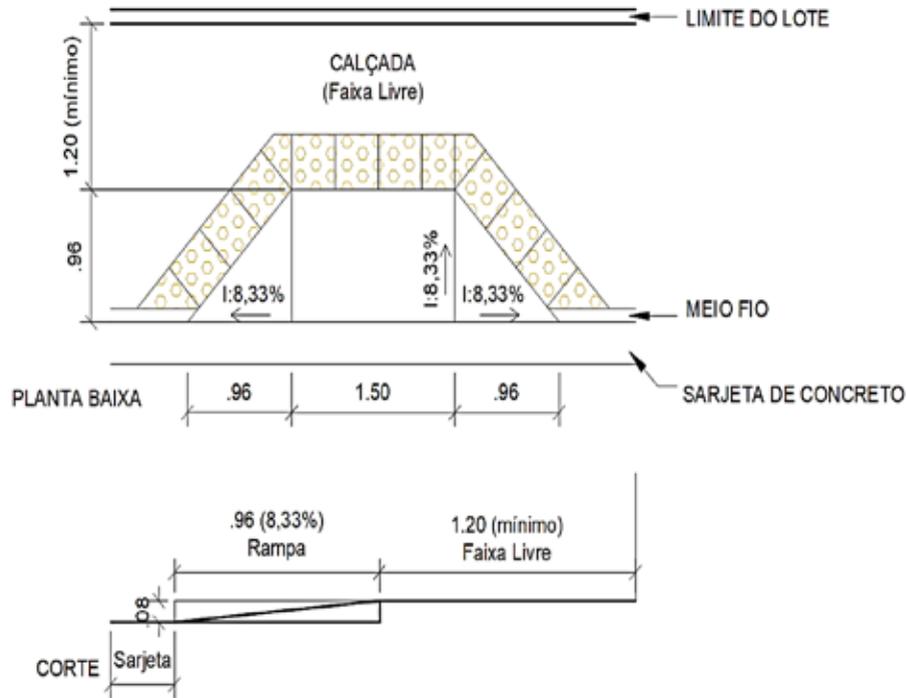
Planta baixa e corte da rampa transversal para calçada com altura de 8 cm
